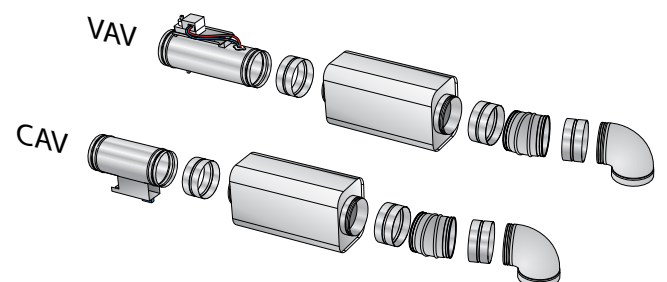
Montage des SA/EA-Sets VAV mit Motorsteuerung und CAV mit manuellem Einstellrad.
